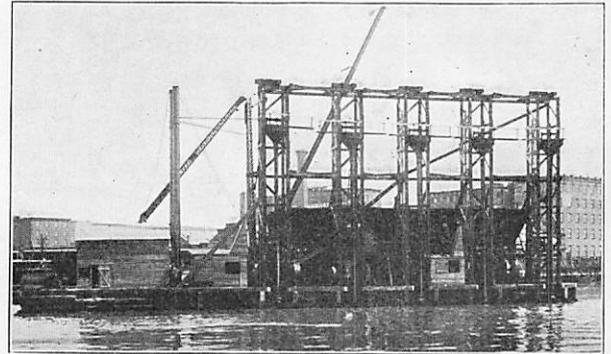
Untergrundbahn der Lexington-Avenue in Neuyork. Bau des Harlem-Flufs-Tunnels. Versenken eines Tunnelstückes. Die Schwimmzylinder ragen noch aus dem Wasser heraus.
